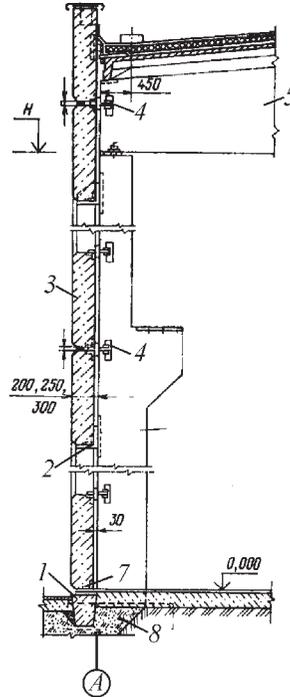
Навесные панели несущих стен: 1 – фундаментная балка; 2 – стальной опорный столик; 3 – легковесная панель; 4 – крепежный элемент; 5 – несущая конструкция покрытия; 6 – колонна; 7 – гидроизоляция; 8 – подсыпка
